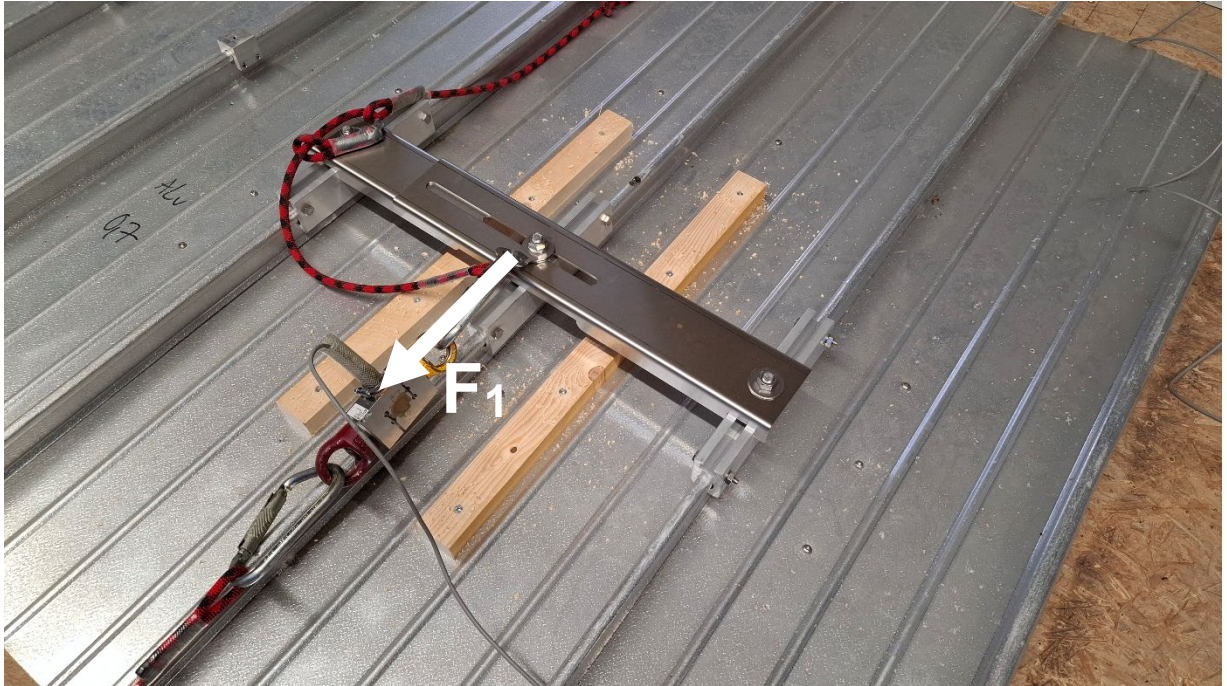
Prüfaufbau A, Anschlagereinrichtung, Typ: ABS-Lock® Falz VI mit der Position und Richtung der Krafteinleitung, Scharenbreite: 400 mm
